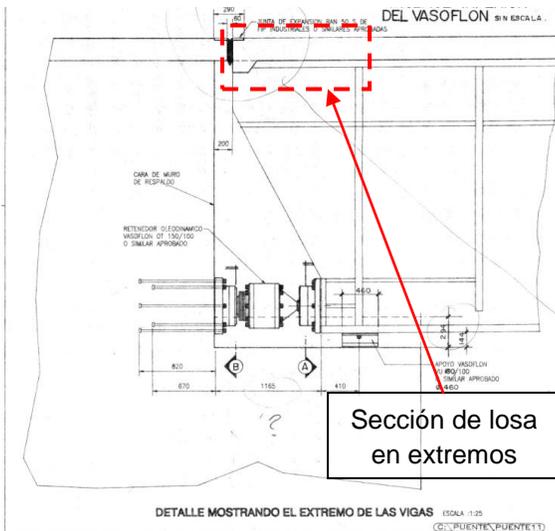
Grietas en los extremos de la losa del puente cerca de las juntas de expansión
